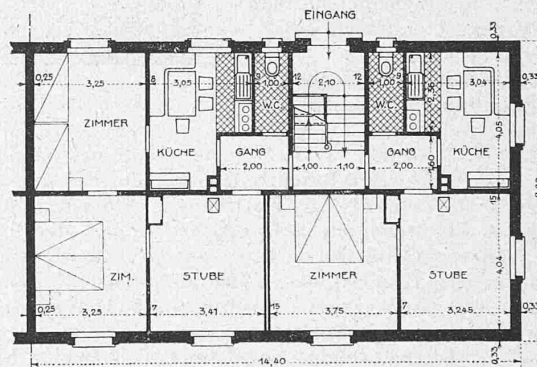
Grundriss eines Flügel-Hauses. — 1:200.
